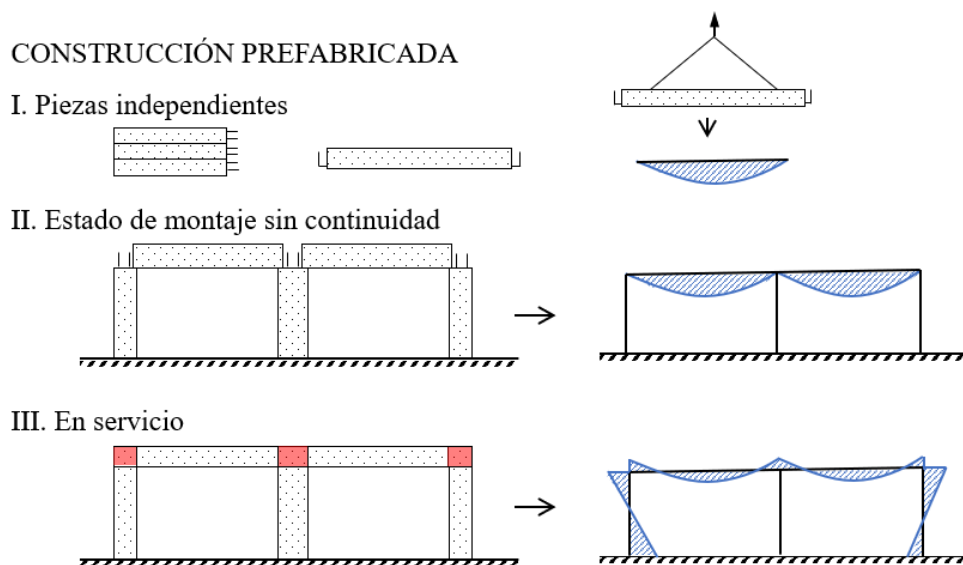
Etapas de un elemento prefabricado pretensado.
